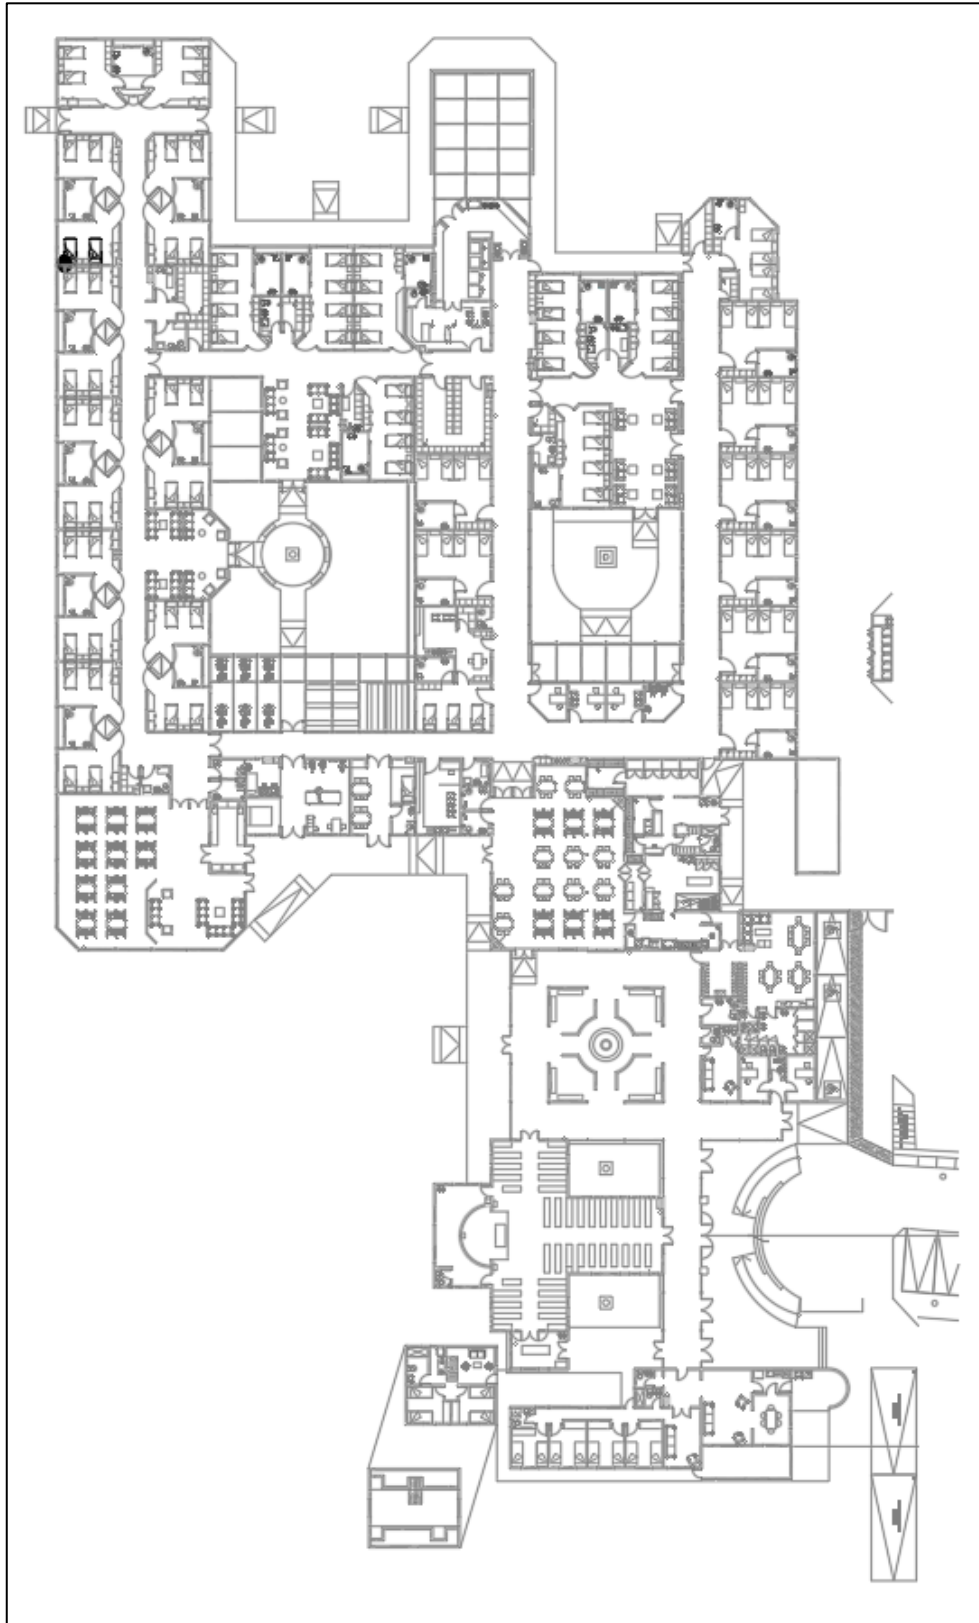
Planta de arquitectura hogar María Olga Tuñón de Barriga.
